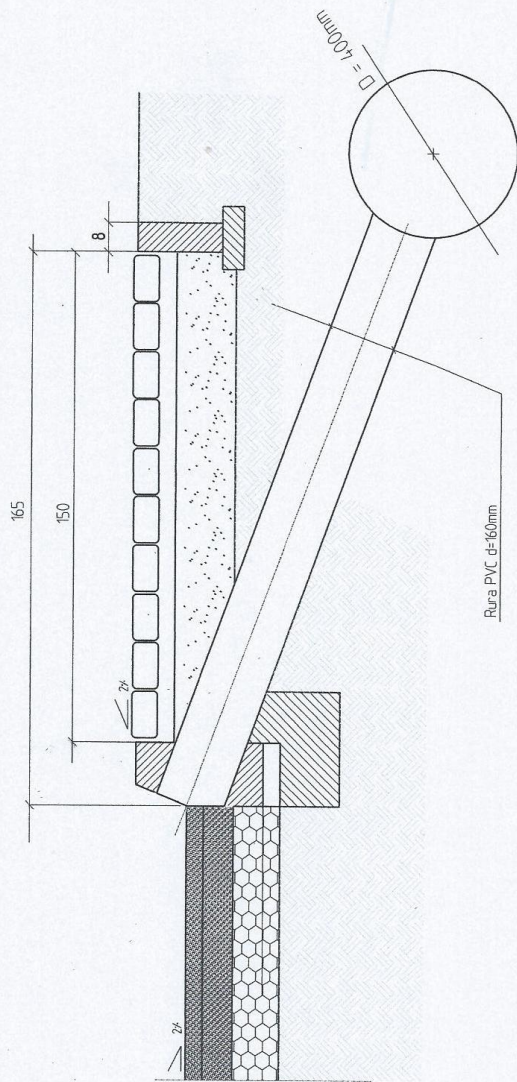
Konstrukcja wpustu pochodnikowego (przekrój B – B).
